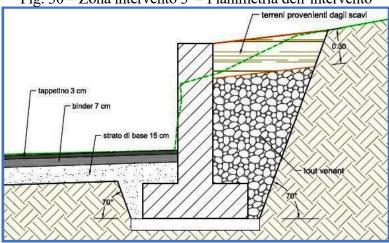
Zona intervento 3 – Sezione tipo del muro in c.a.
